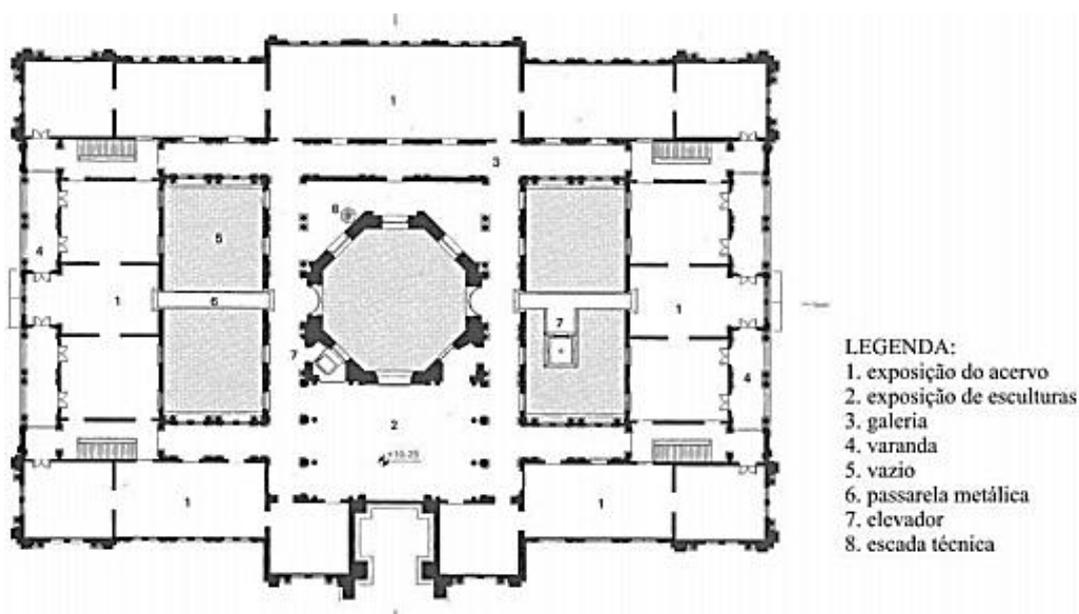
Planta do segundo pavimento da Pinacoteca.
